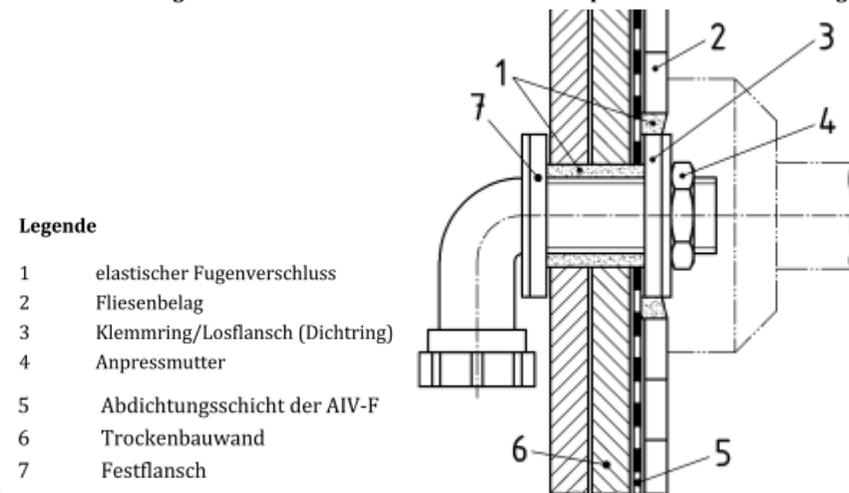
Rohrdurchführung bei einer Trockenbaukonstruktion mit Anpressmutter und Dichtringen
